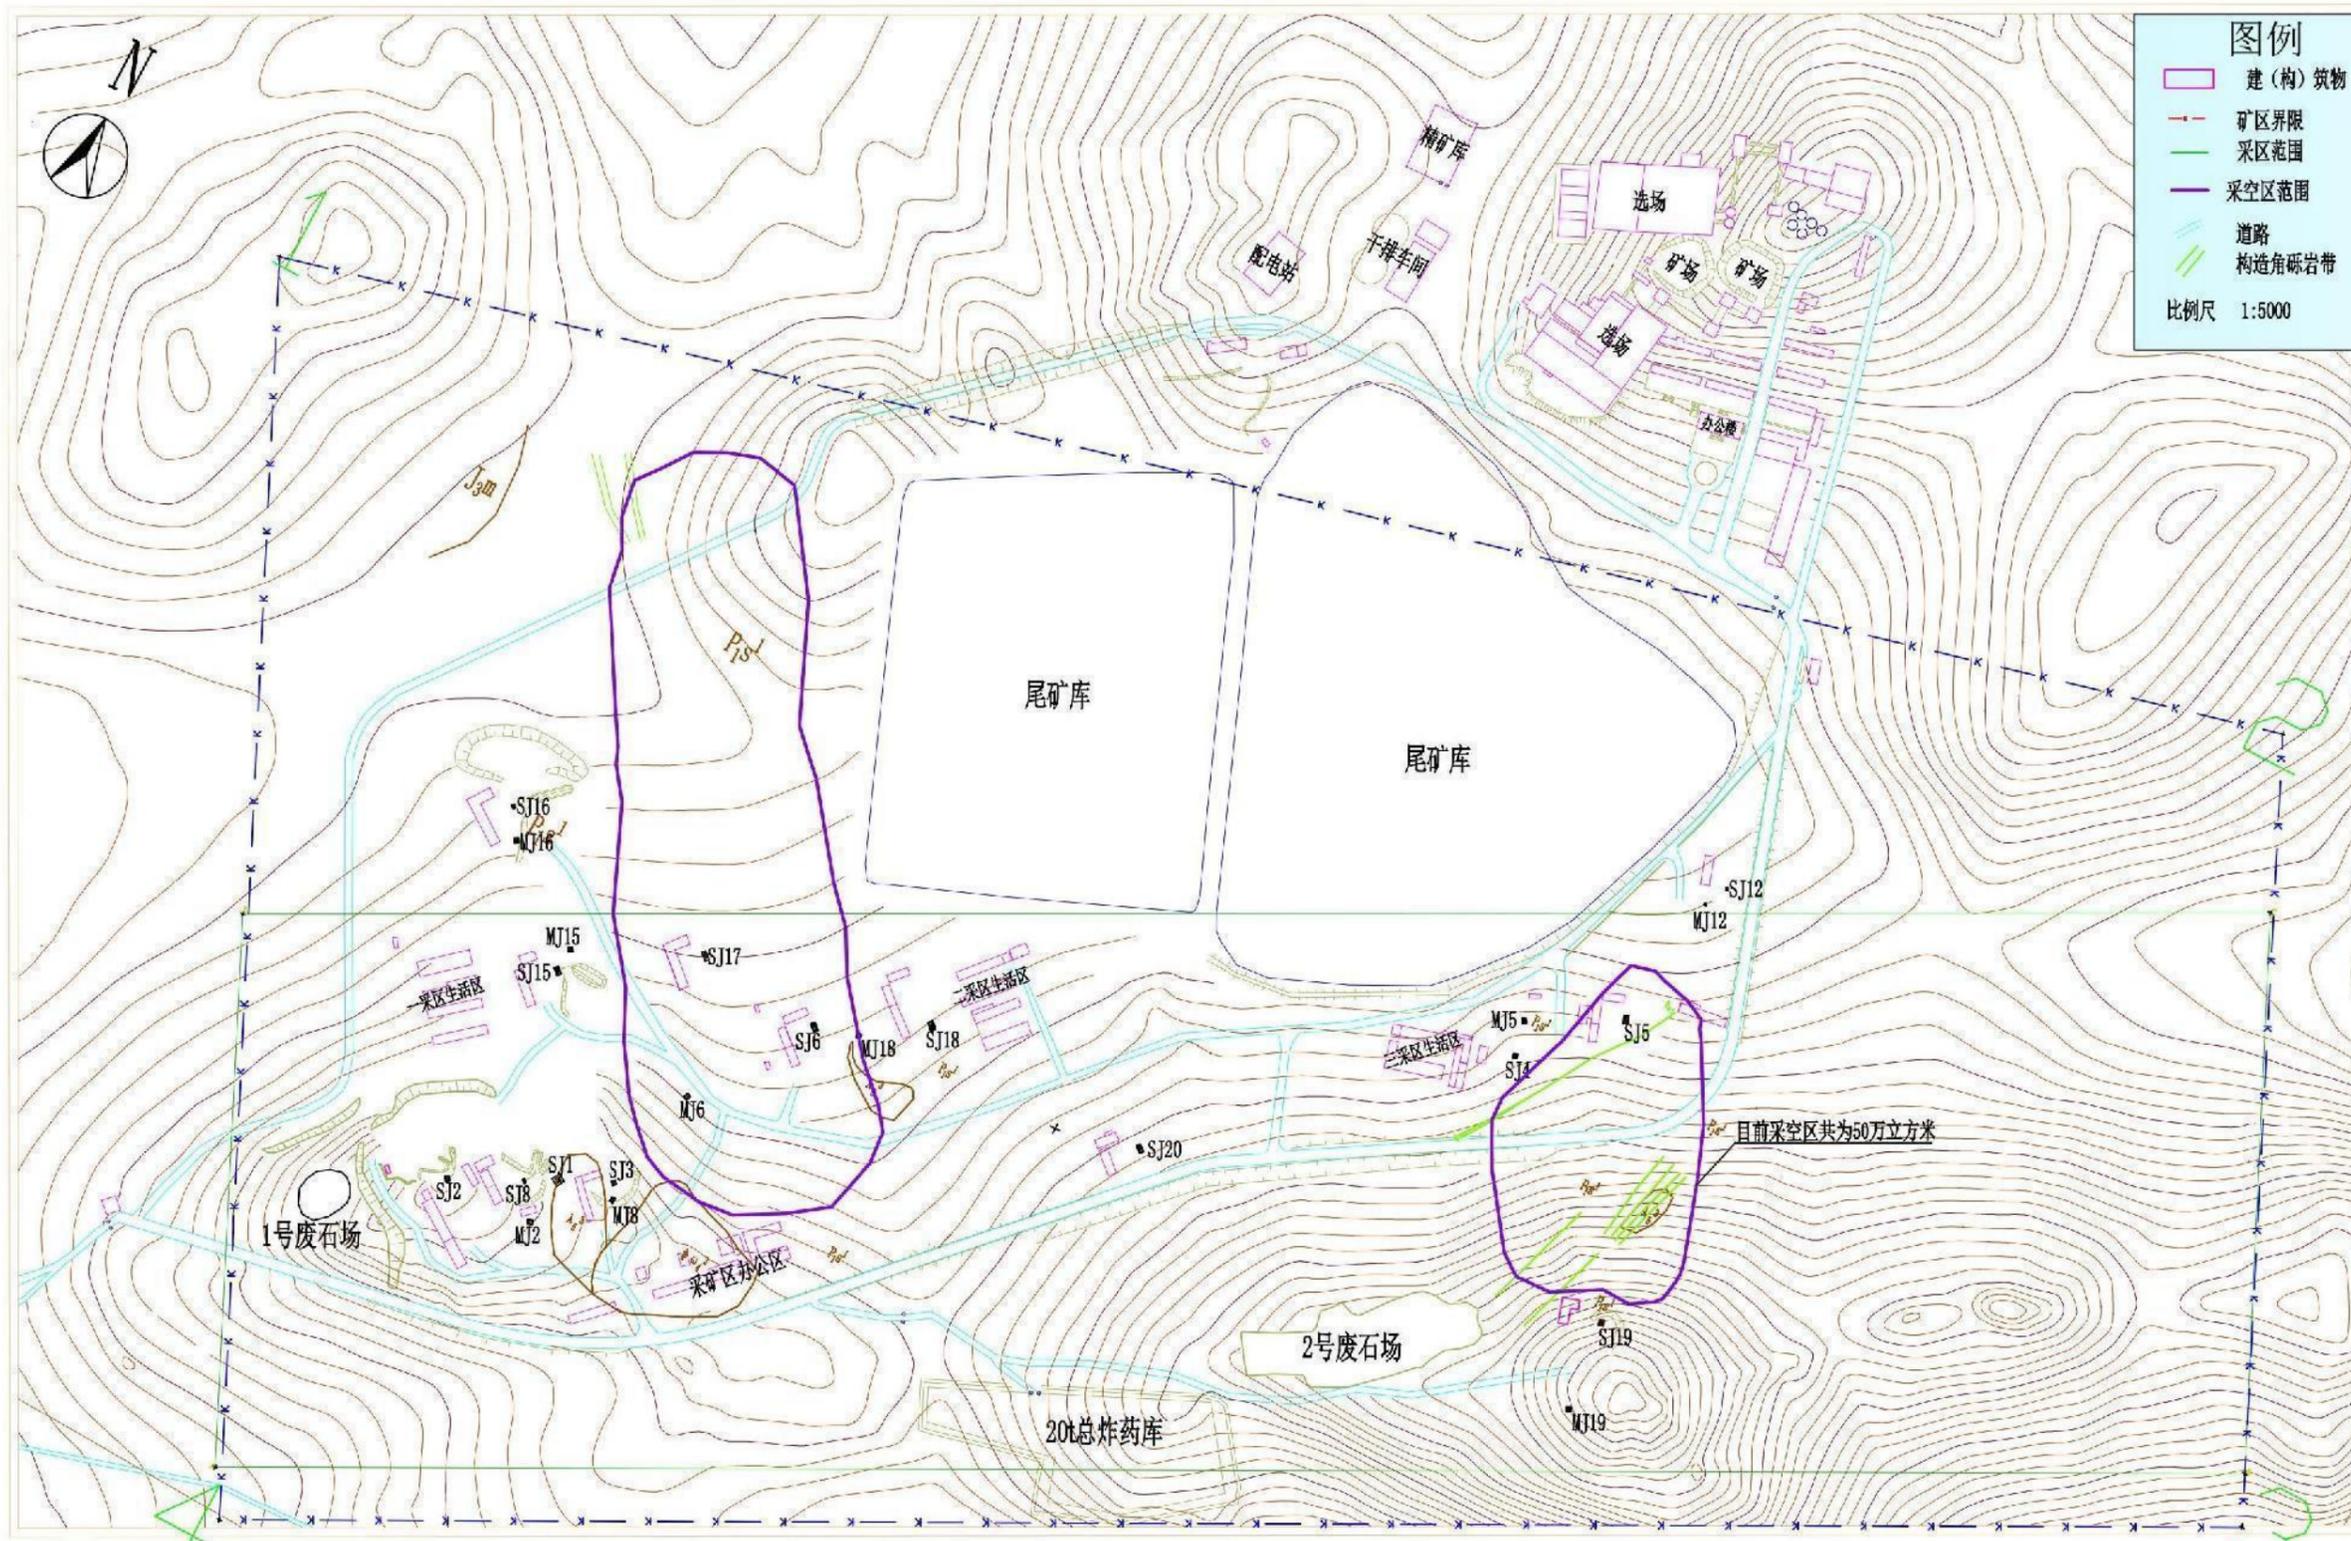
技改前项目总平面布置图（竖井位置及分布）
